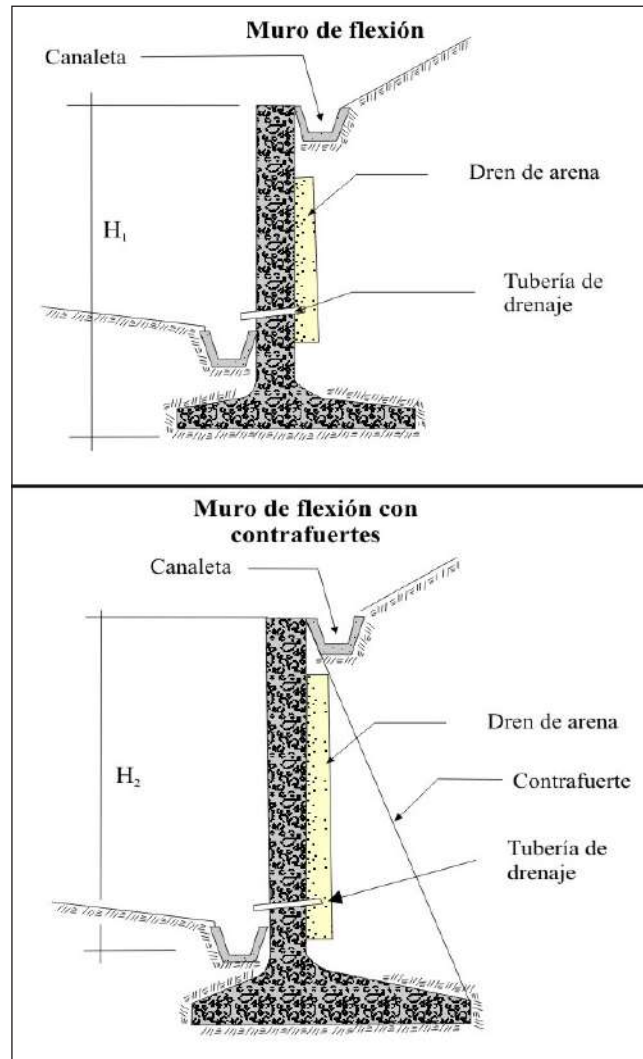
Muros de concreto armado tipo flexión (tomado de Ingemmet, 2000)
